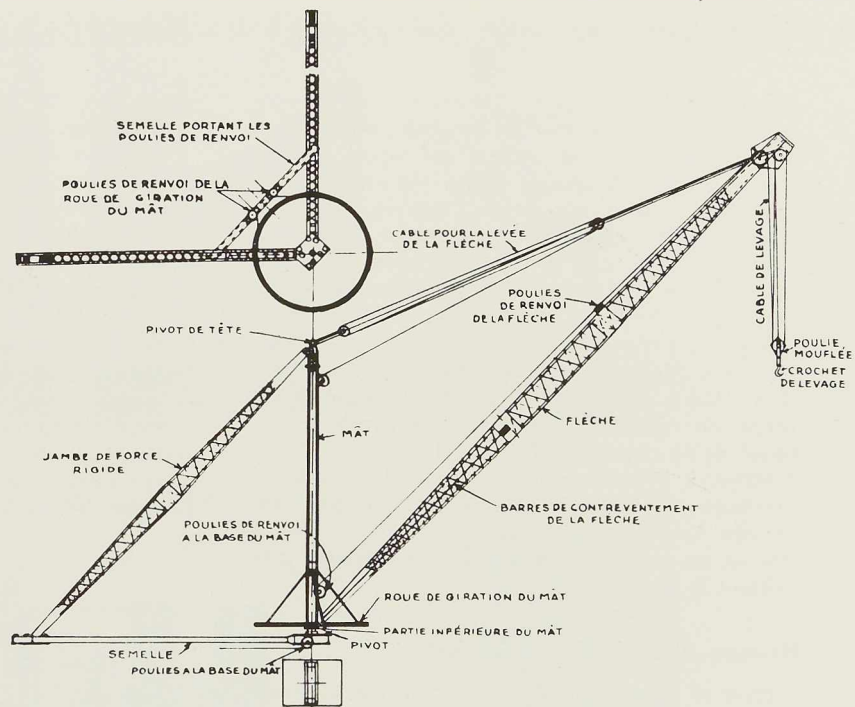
Vue en élévation et en plan d'un derrick à jambes de force rigides à longues semelles de liaison.
